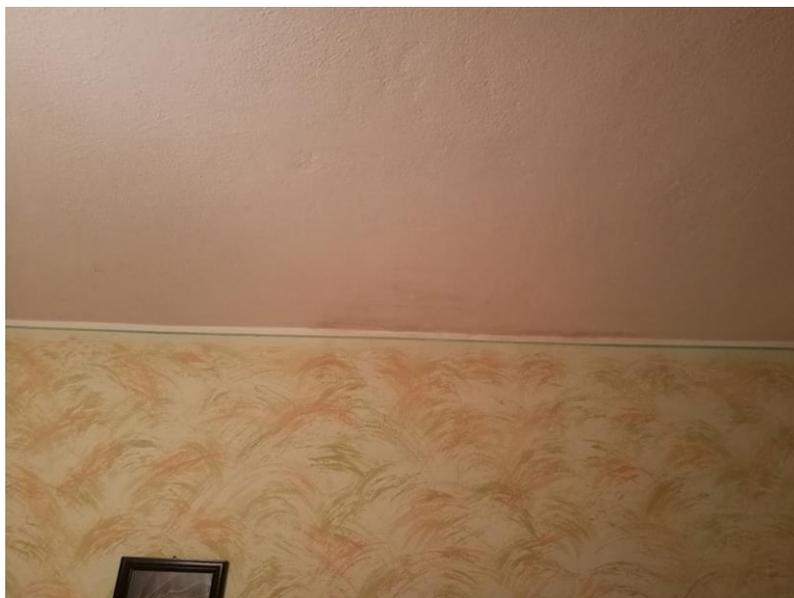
PIANO PRIMO – particolare soffitto camera da letto.
